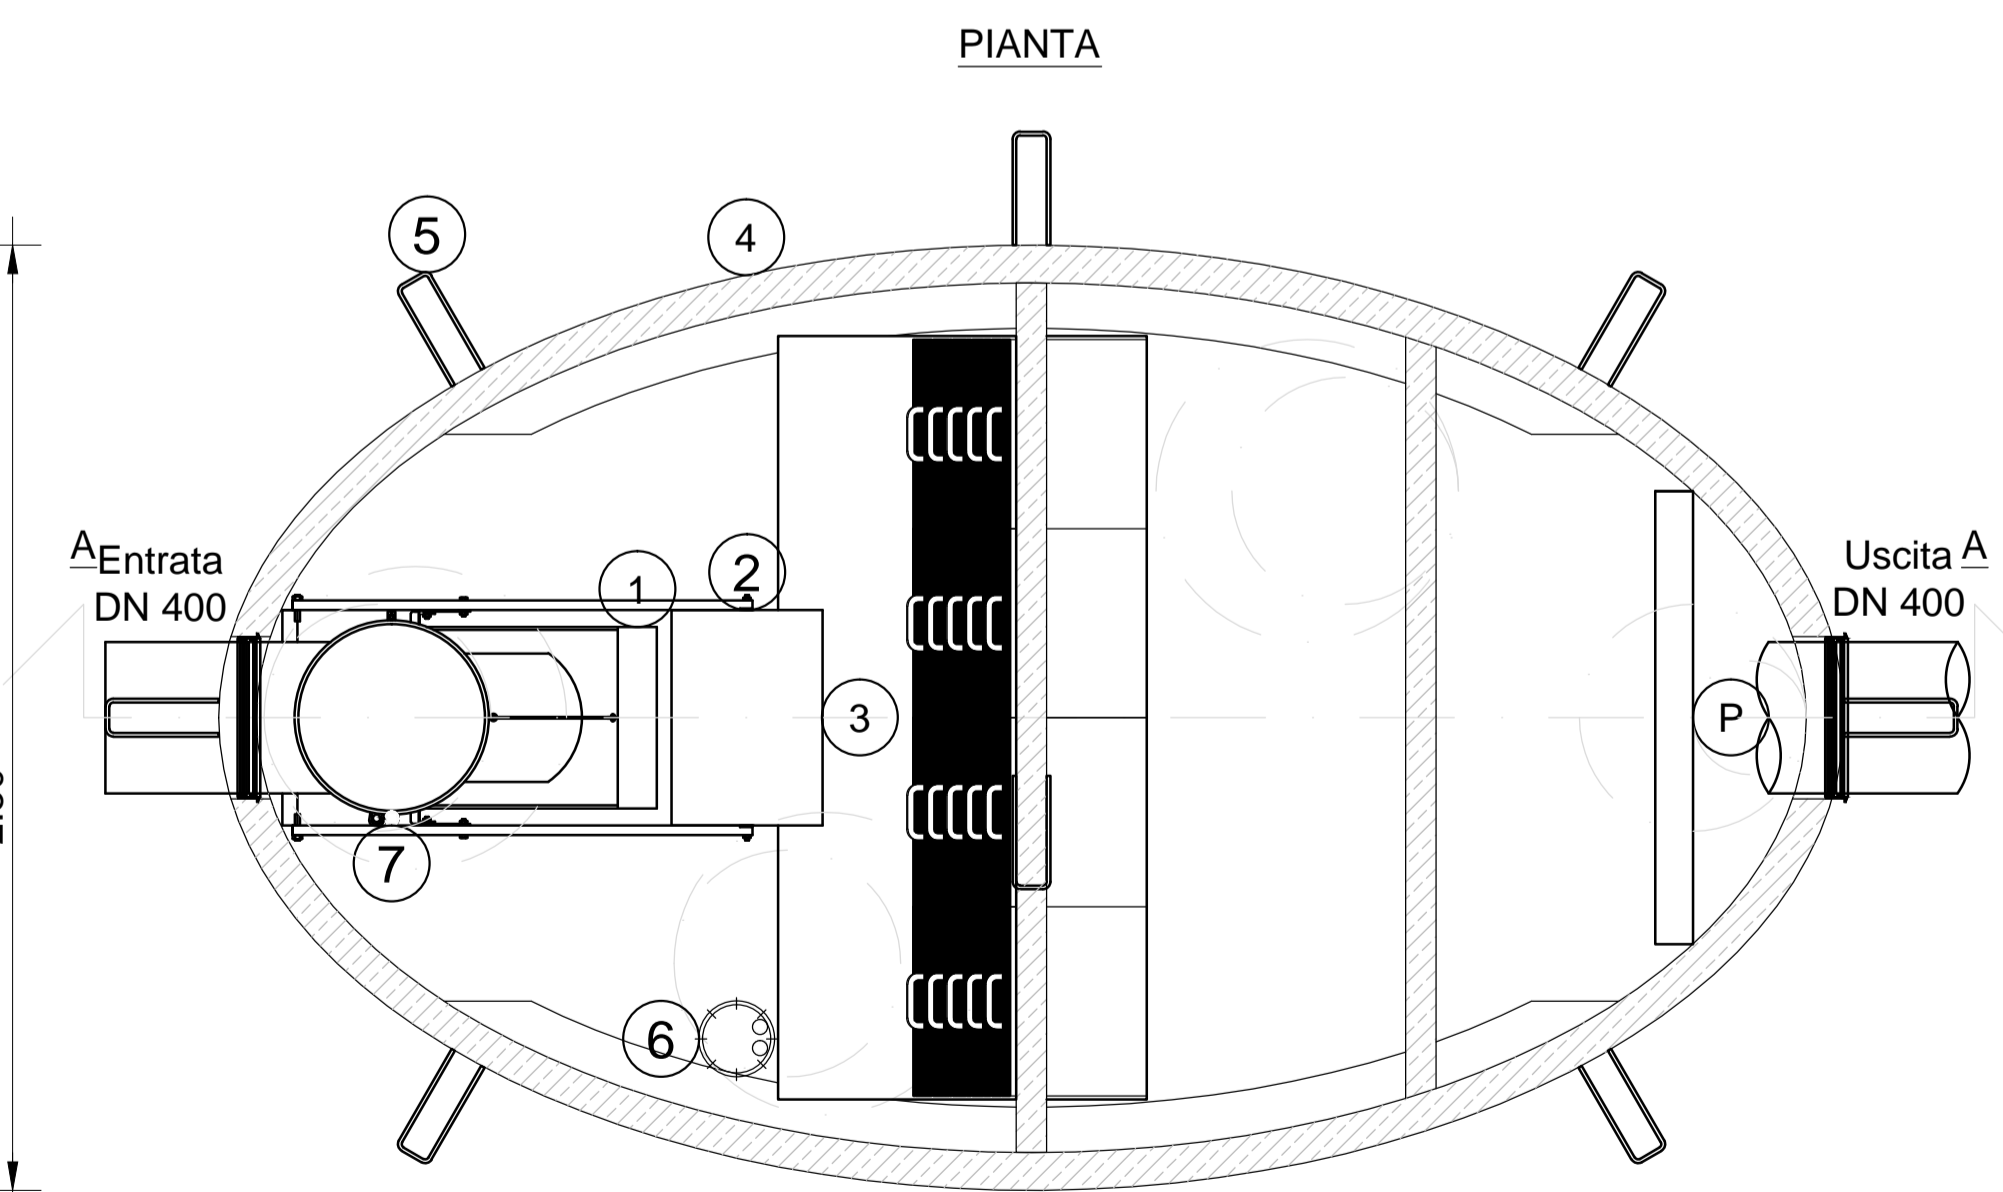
PLATEA DI FONDAZIONE IN C.A. DEL DISOLEATORE: PIANTA
